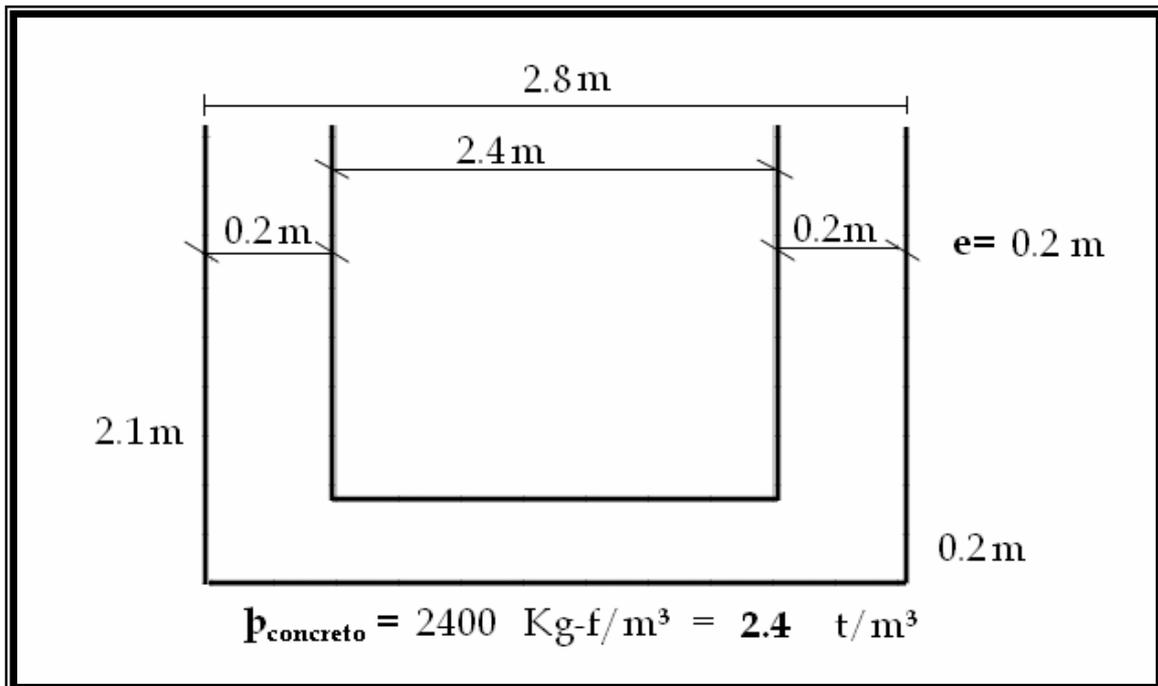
Diseño de la Placa de Fondo – Tanque de almacenamiento
